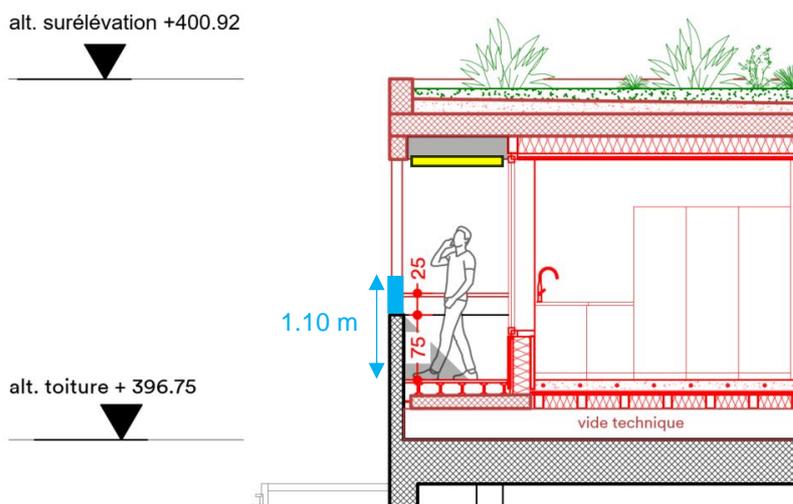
Coupe transversale BB et position de l'écran rehaussé
